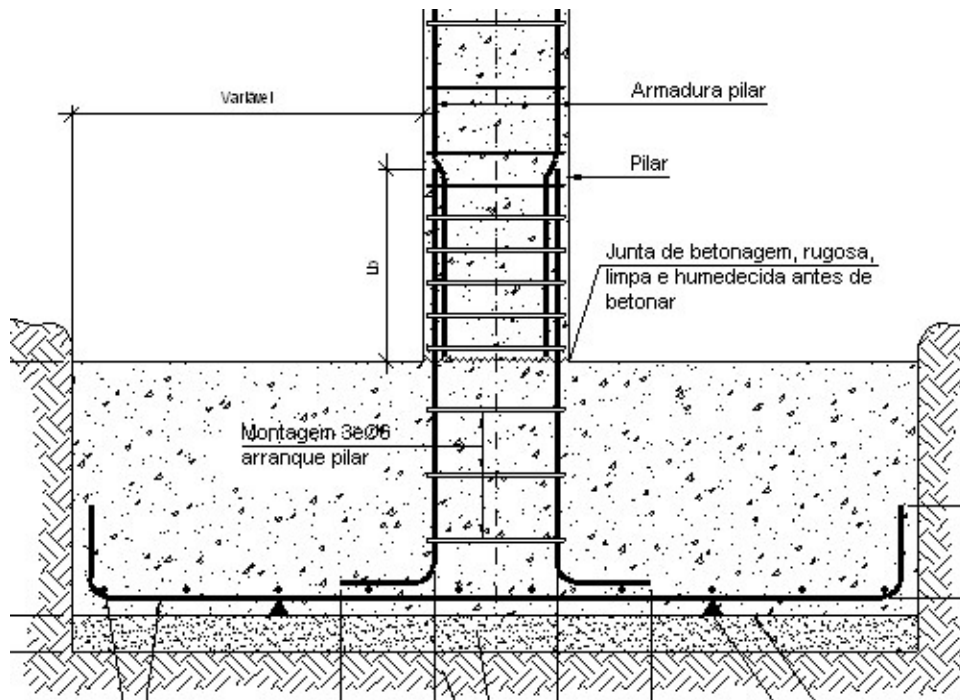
Armadura do pilar e distância de transpasse - Fonte: pormenoresconstrutivos
